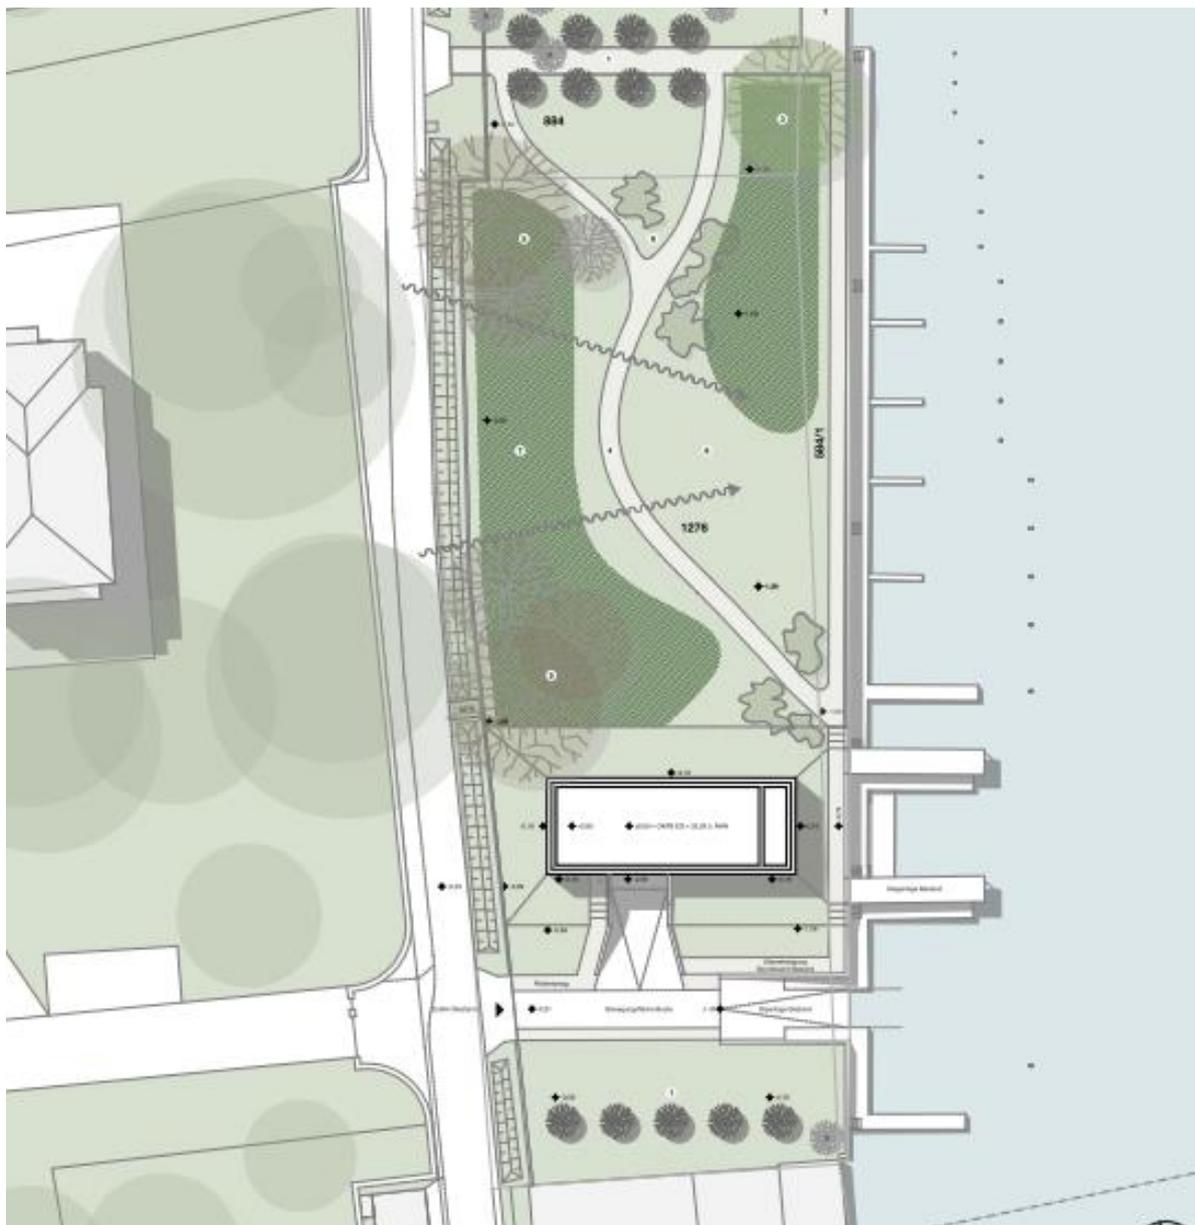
Lageplan Bootshaus mit Außenanlagen gemäß Genehmigungsantrag 2018⁸
